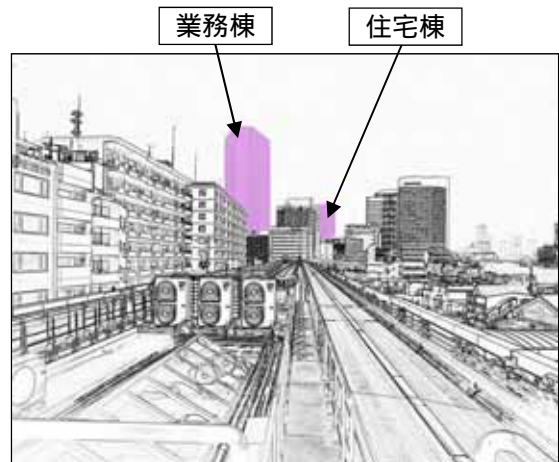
(2) 眺望の状況 (No.9 : 日の出駅ホーム) 【変更前】
